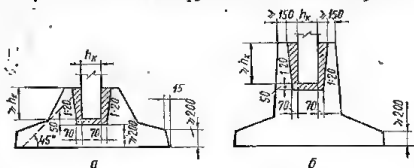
Пирамидальный фундамент со стаканом для заделки сборной колонны:
